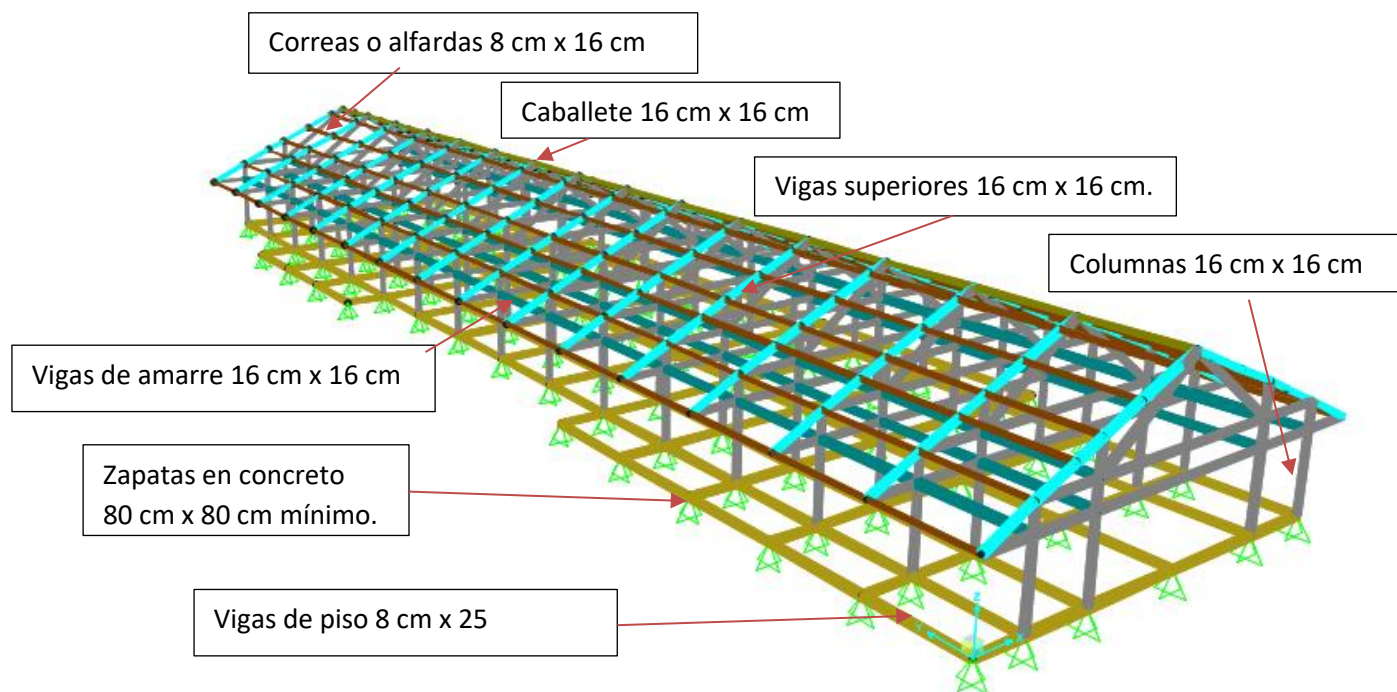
Posición de los elementos de madera y concreto en la obra.
